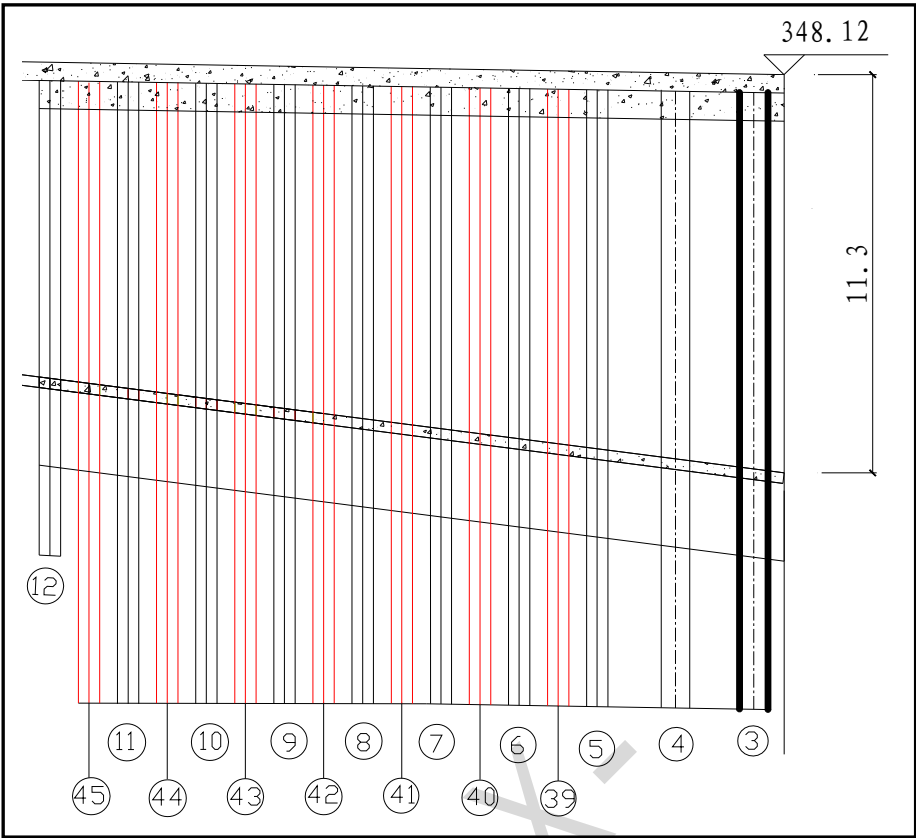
17.5m 桩长区最危险桩 3#桩示意图（尺寸单位：m）
